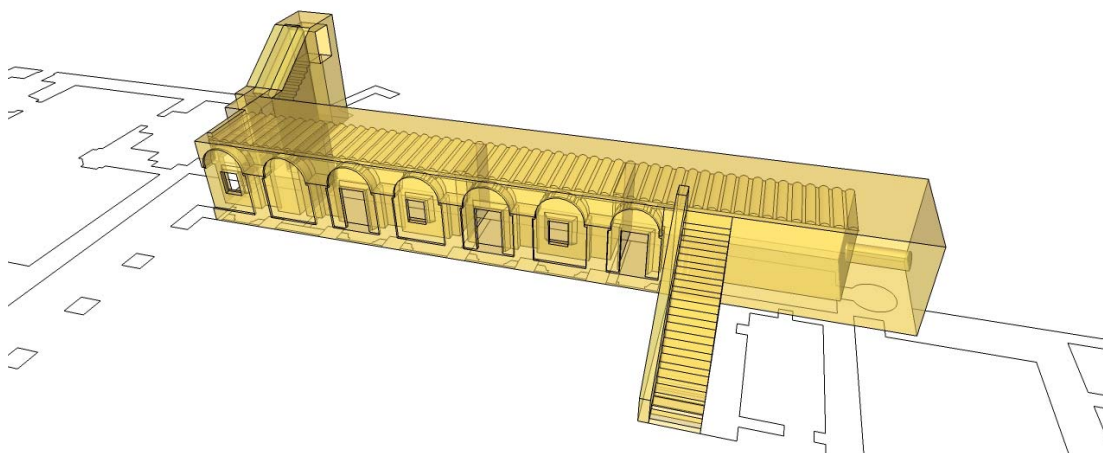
Reconstrucción Virtual Sector 2 a: Ala Oeste Planta Baja
